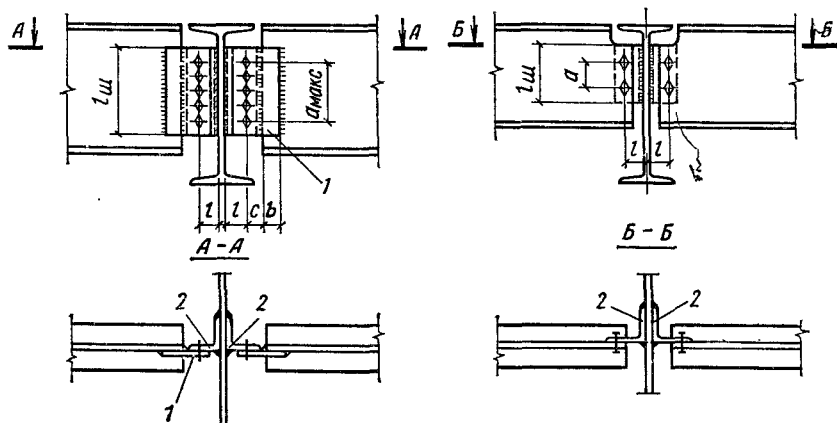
Соединение второстепенной балки с главной в одном уровне на болтах
